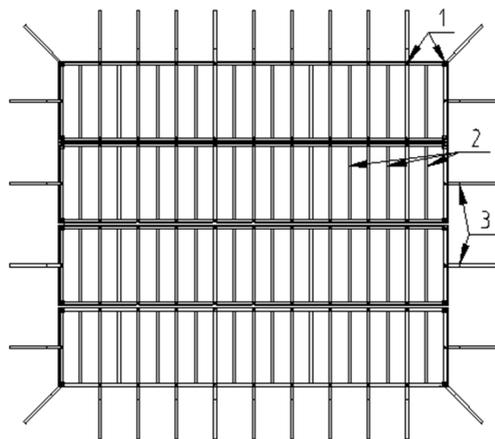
План защитного сооружения гражданской обороны из четырех блок-модулей: 1 — вертикальные стойки; 2 — поперечные балки усиления перекрытия; 3 — контрфорсы
